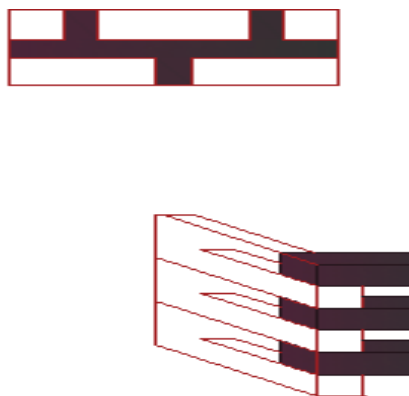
Mampostería de Bloque y Terro-Cemento
